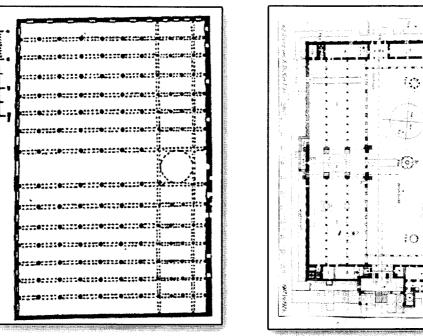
جامع الأزهر (مسقط أفقي) عن : دوريس أبو يوسف
